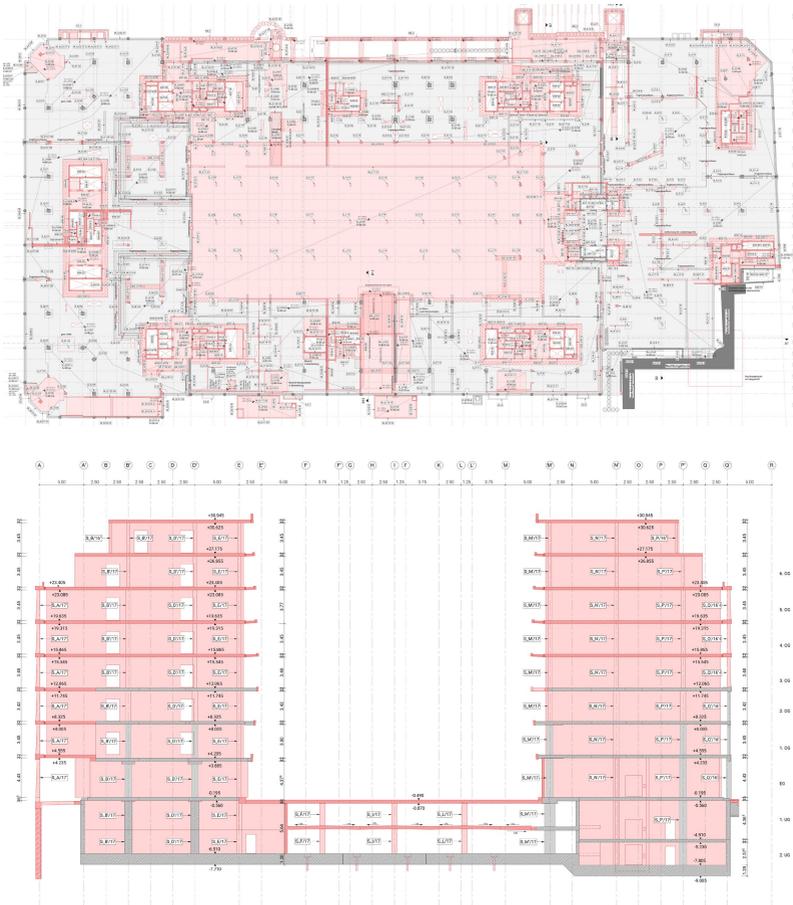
Auszug Positionsplan (Grundriss und Schnitt) INGE Elementum
